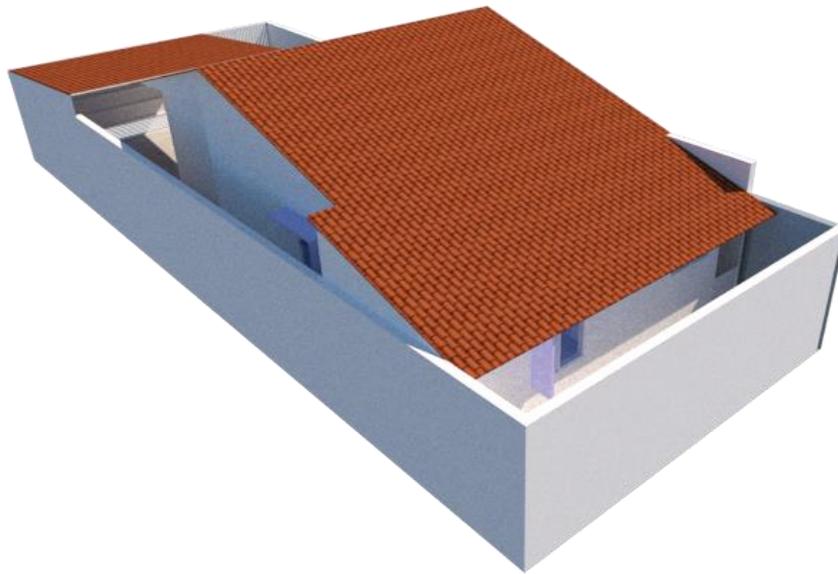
Proposta orientada à Sudeste - Fachada posterior
